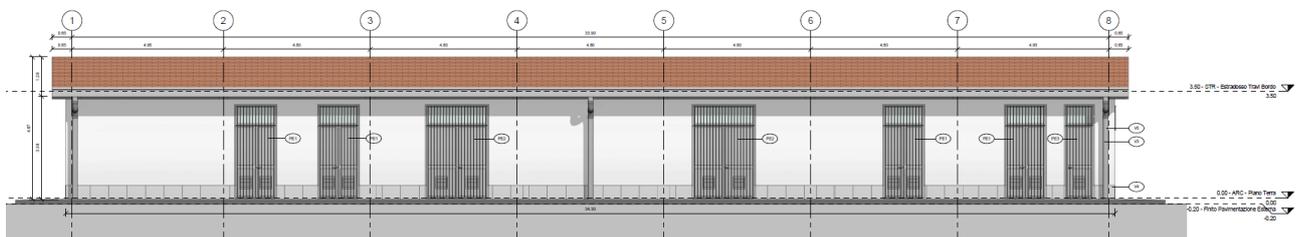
GA Nord – Prospetto Est (Opposto ai Binari)
